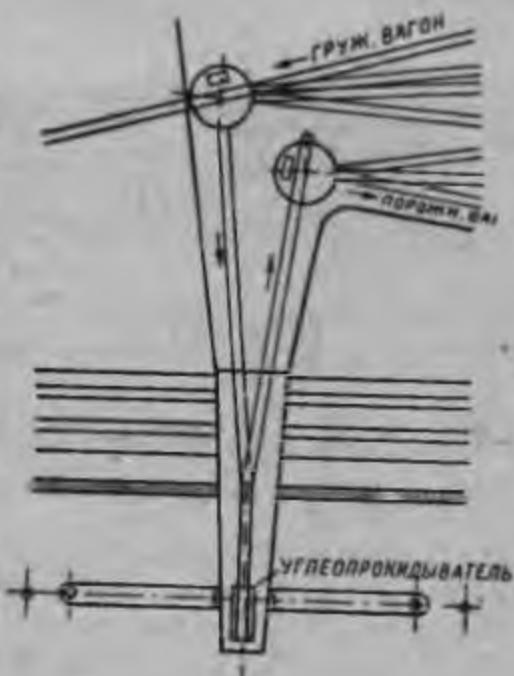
План расположения поворотных кругов перед углеопрокидывателем у причального фронта.
